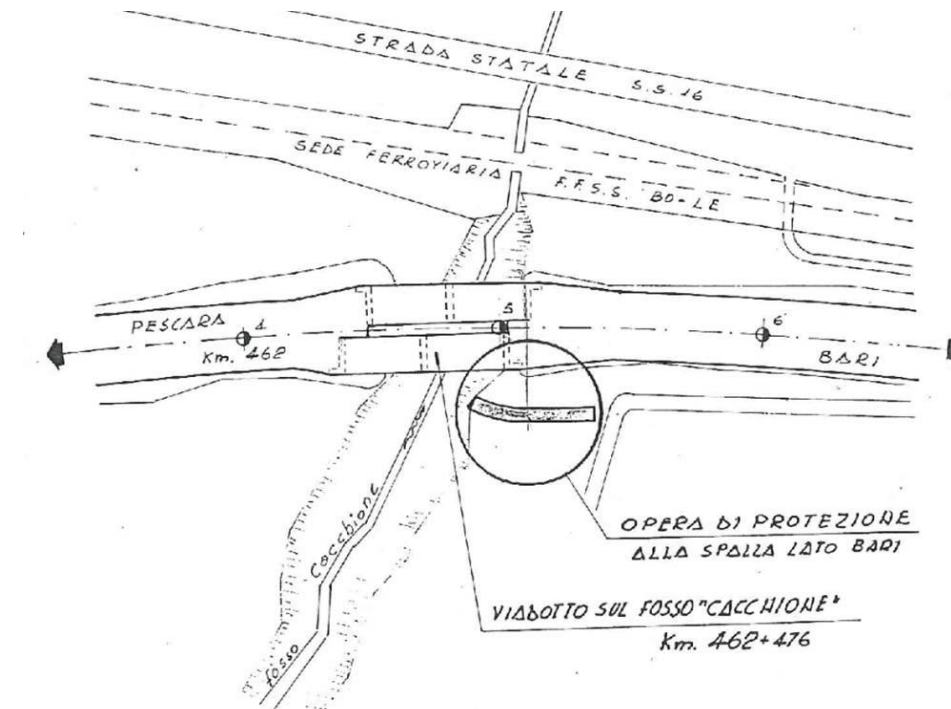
Posizione paratia di pali a protezione delle spalle lato Bari
